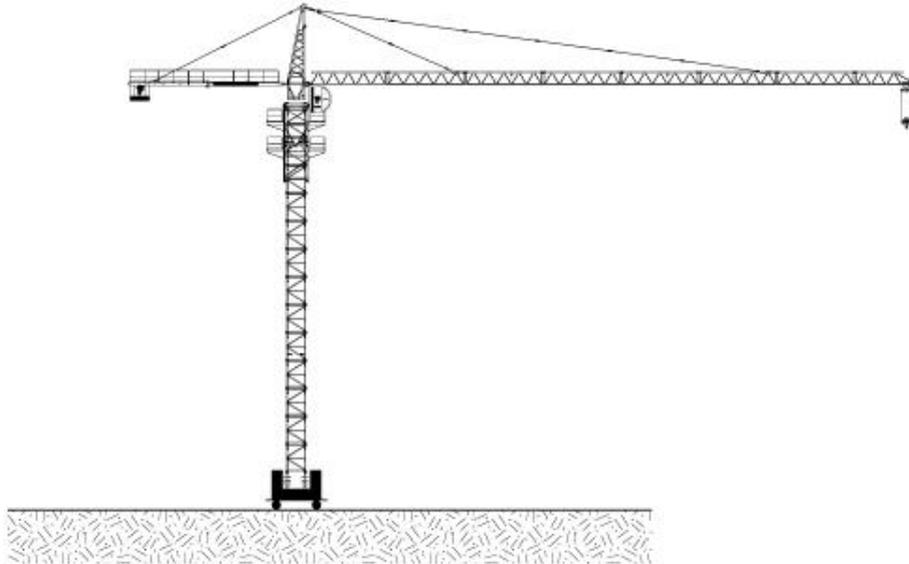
Esquema de uma grua assente em carris (fonte: pingon)
